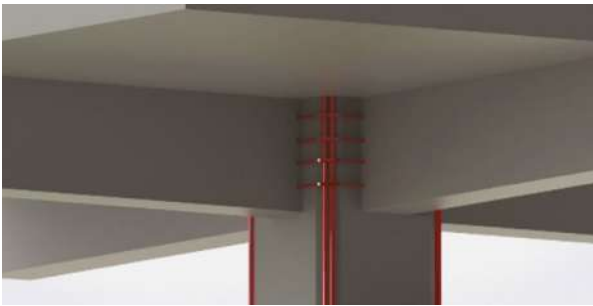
Detalle de amarres laterales para las barras longitudinales dentro de la longitud de la viga
